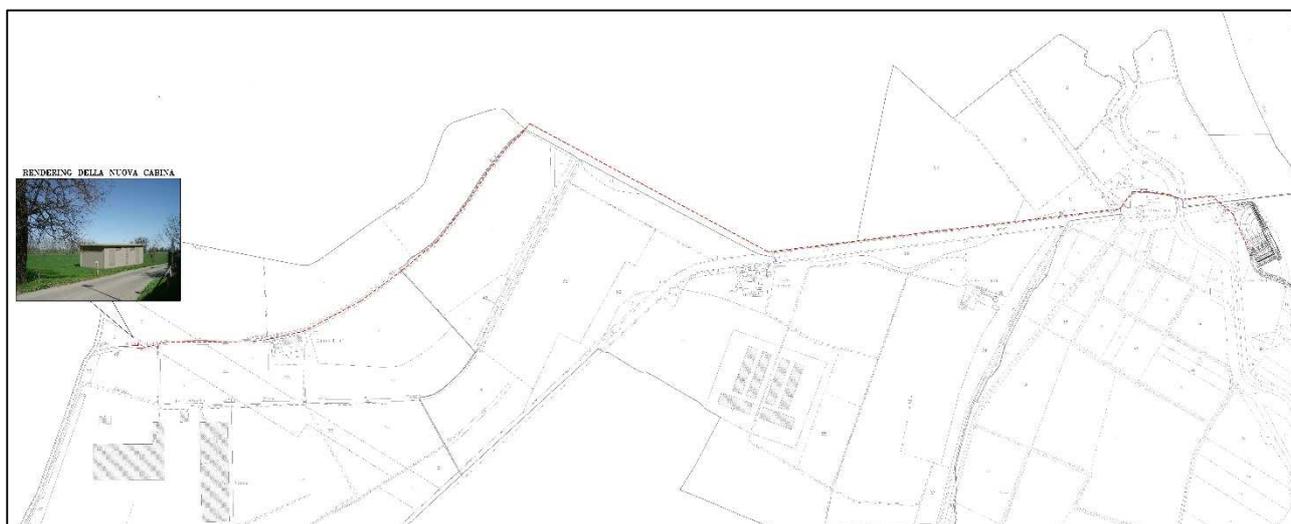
1: Estratto planimetria di progetto del tracciato della linea elettrica (elaborato 004755 Collegamento ENEL – planimetria e sezioni)
